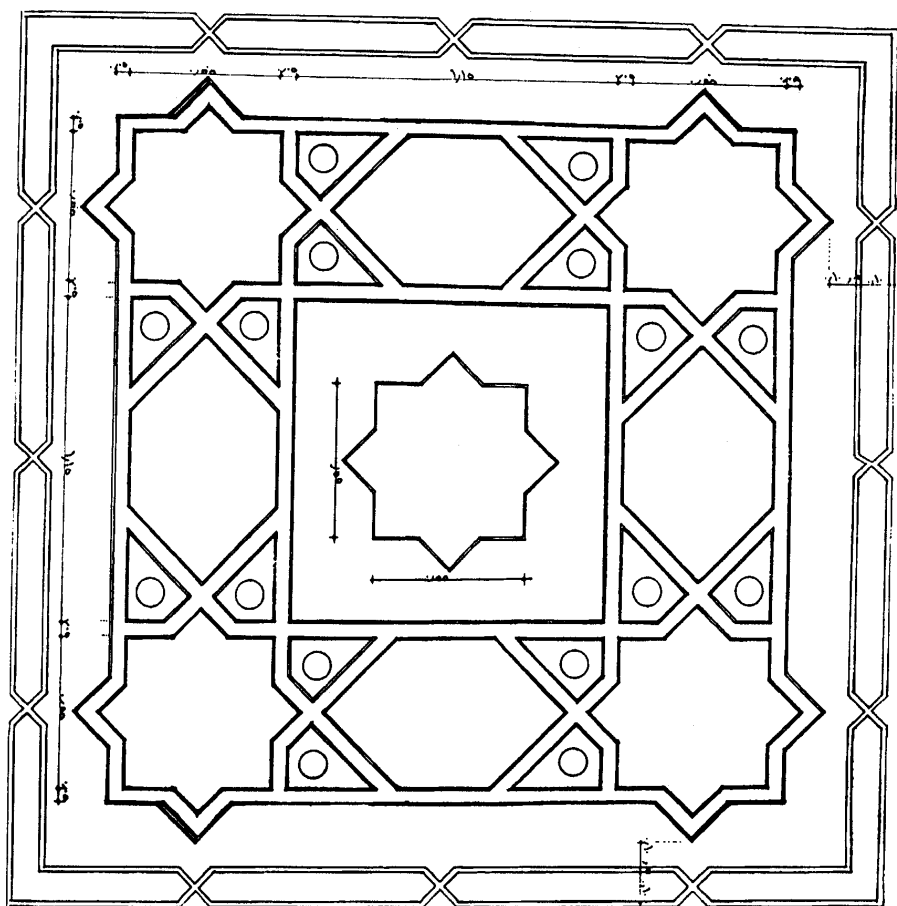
مسقط أفقي سقف خشبي لمحل سياحي بالاقصر (تصميم المؤلف)
